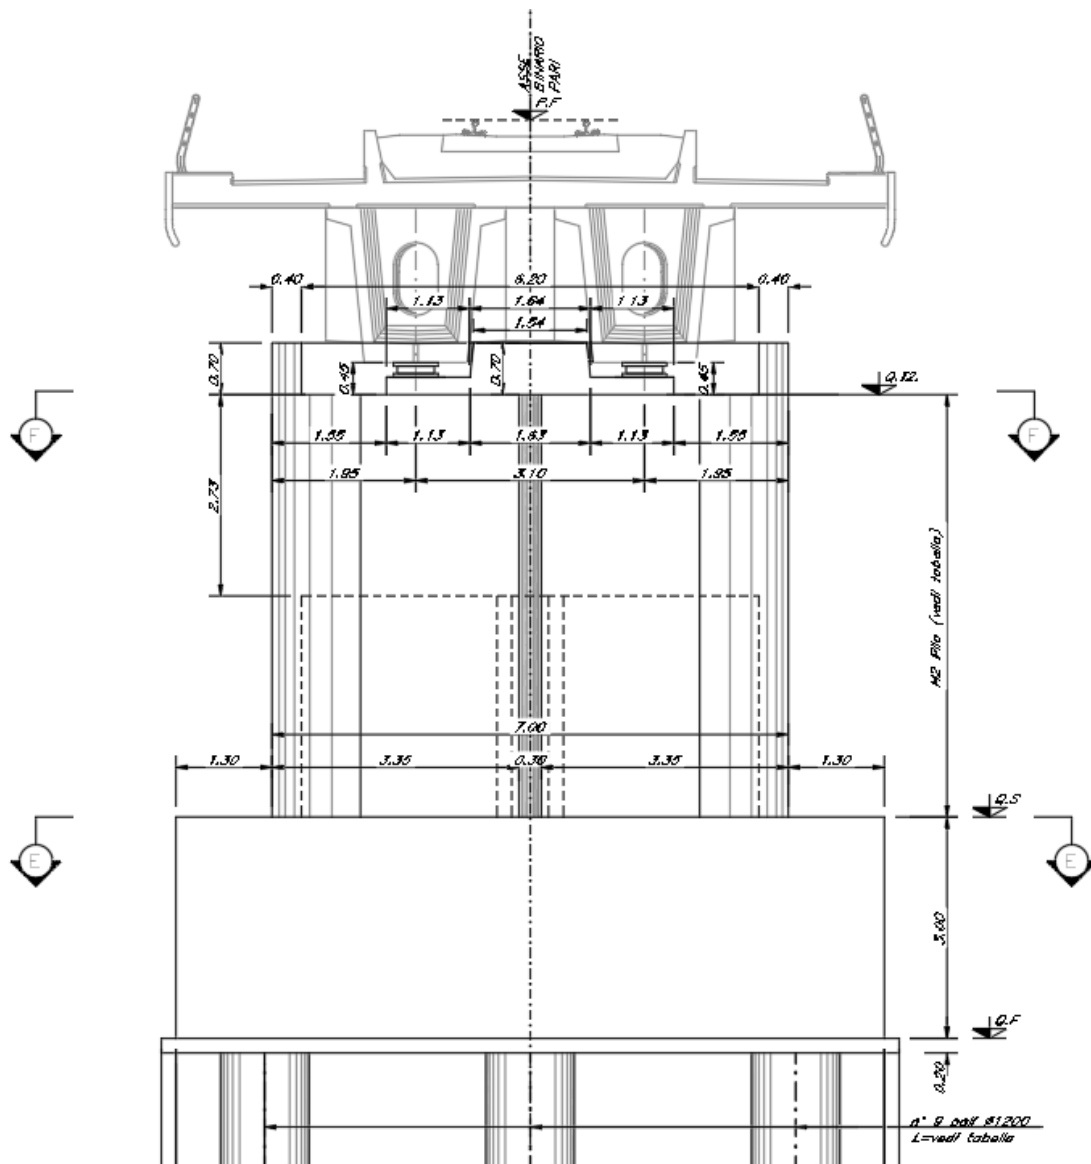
Pila scatolare singolo binario – prospetto trasversale
